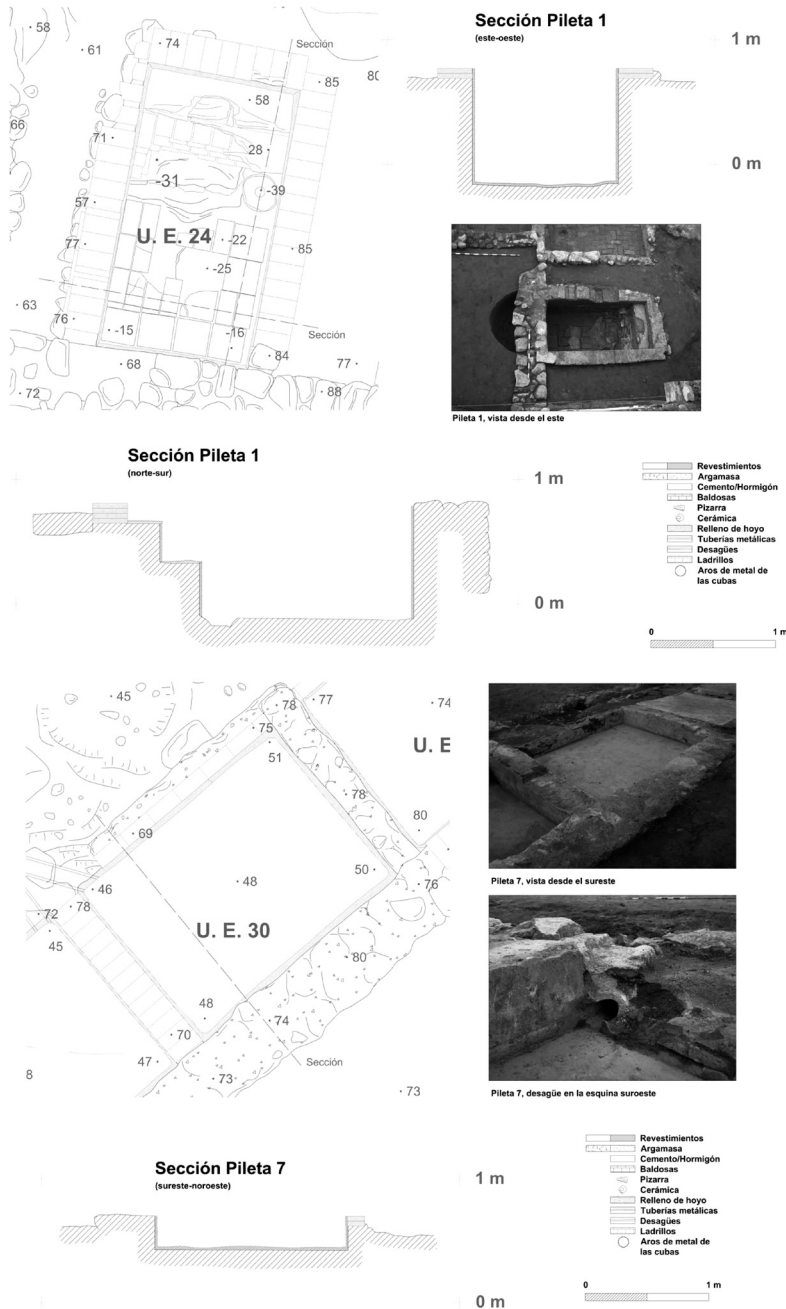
Plantas y secciones de la piletas 1 y 7.
